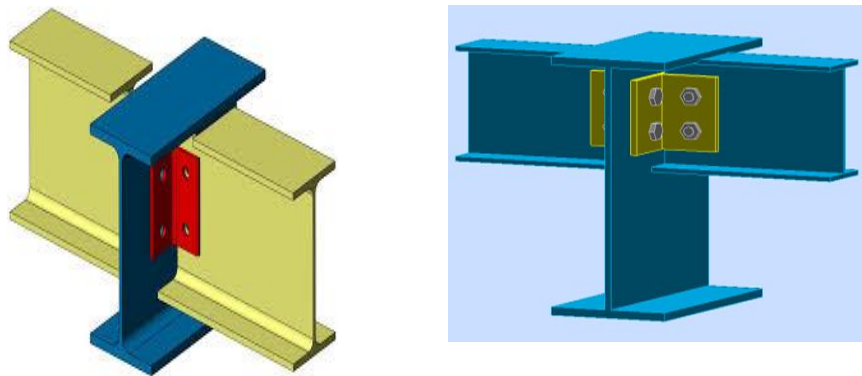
Schéma de l'assemblage poutre – solive.
